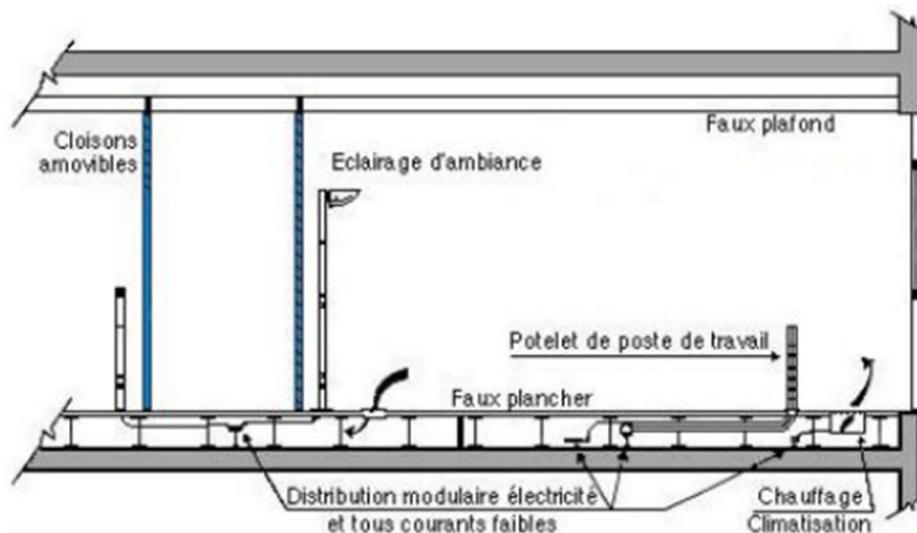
8 présentation du faux plafond et faux plancher des bureaux. Source :(SOUAMI, 2011)
